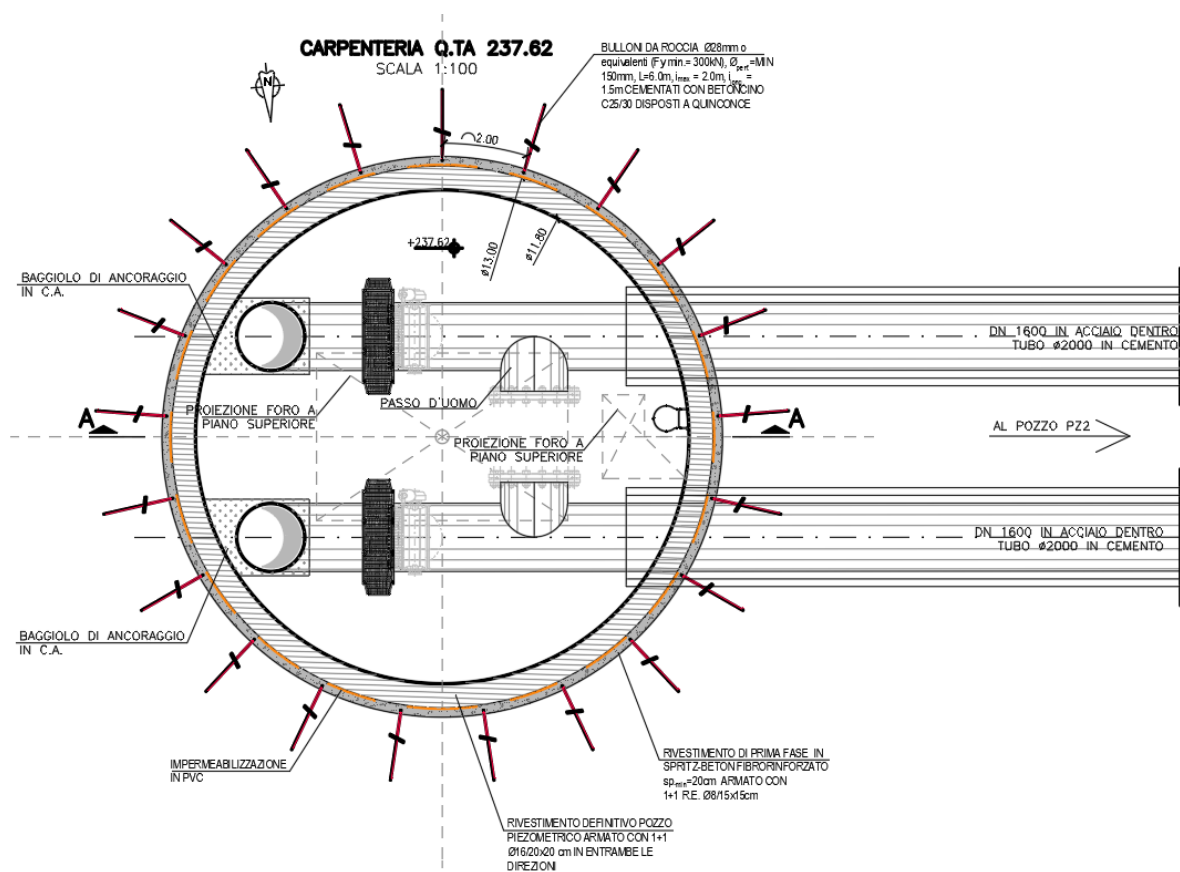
Rappresentazione in pianta del manufatto PZ1
